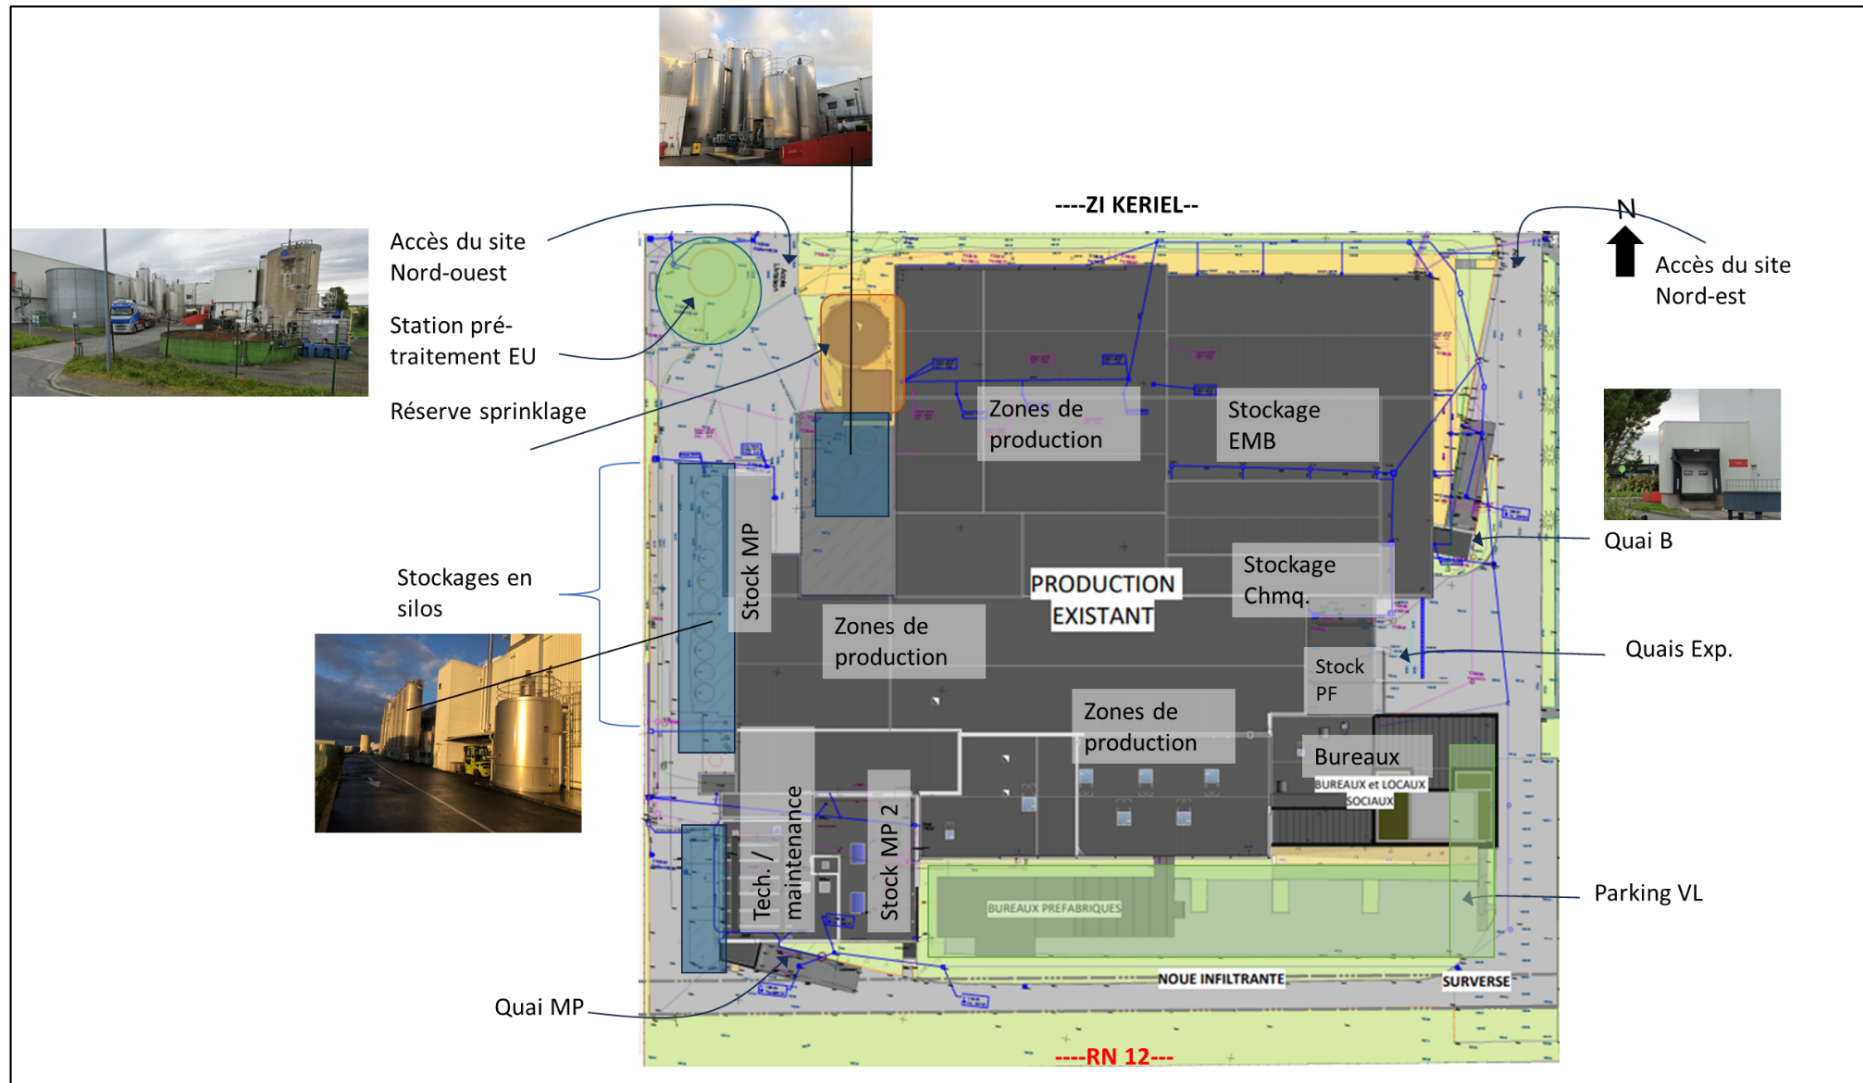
Plan général : Plan simplifié de l'usine (Source : INGEA d'après données FAURE)
